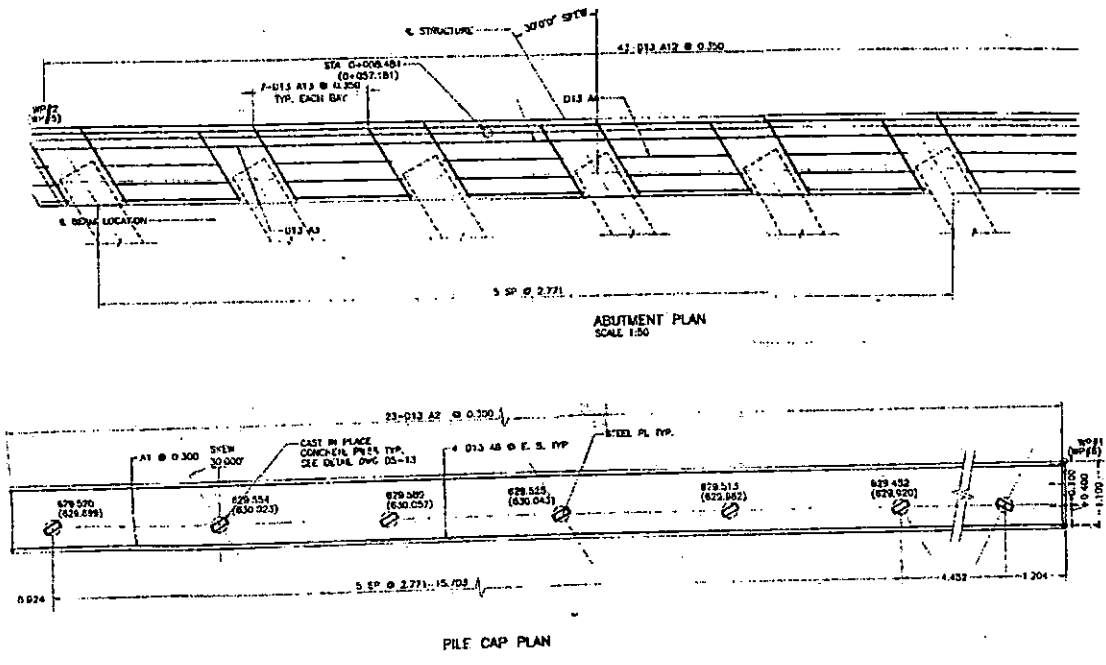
VISTA EN PLANTA DE ESTRIBOS.
